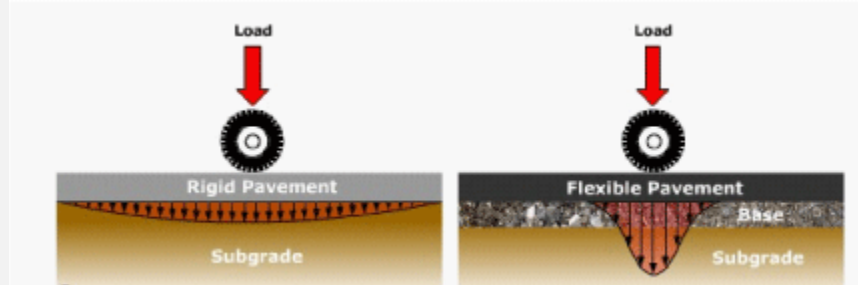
Distribución de las tensiones en los pavimentos rígido y asfáltico.
